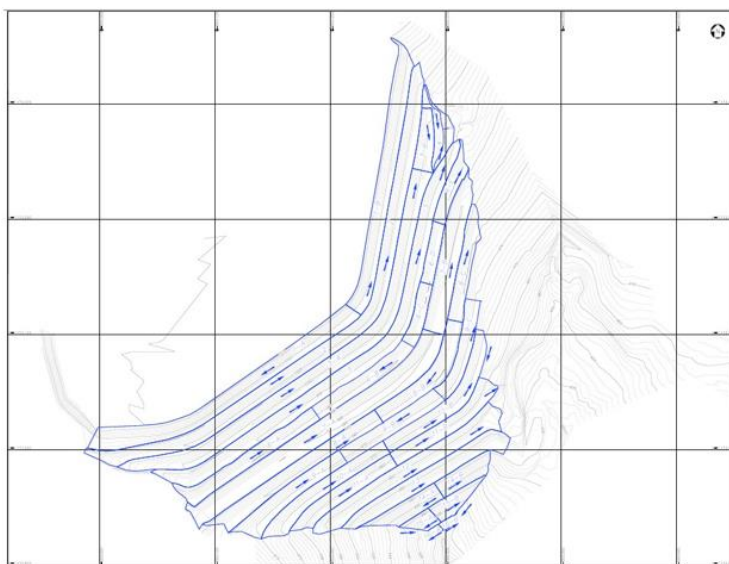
Arranjo para verificação hidráulica do sistema de drenagem das bermas
